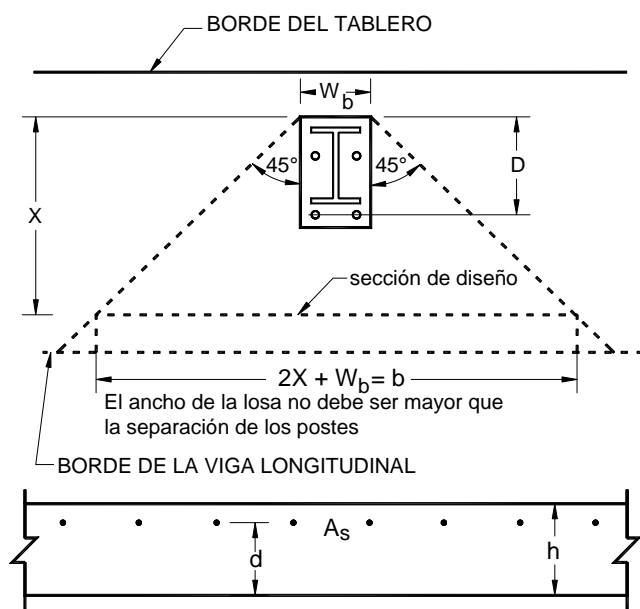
Longitud efectiva del voladizo para soportar las cargas concentradas de los postes, transversales o verticales
